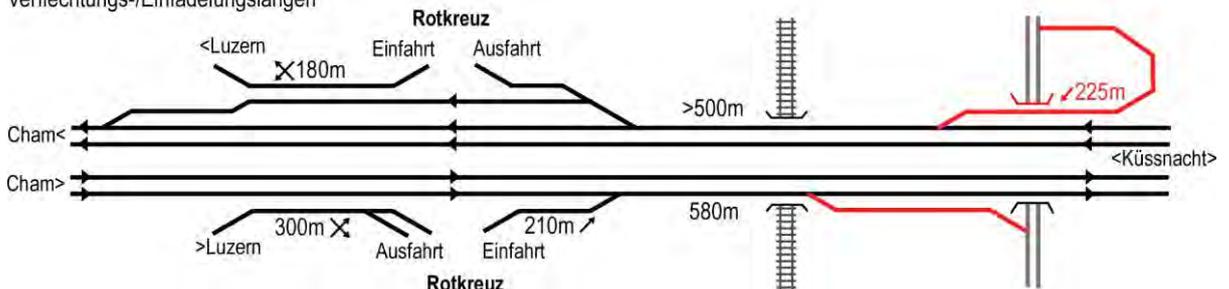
Alternative Lage der Einfahrtsrampe Buonaserstrasse Richtung Nord
